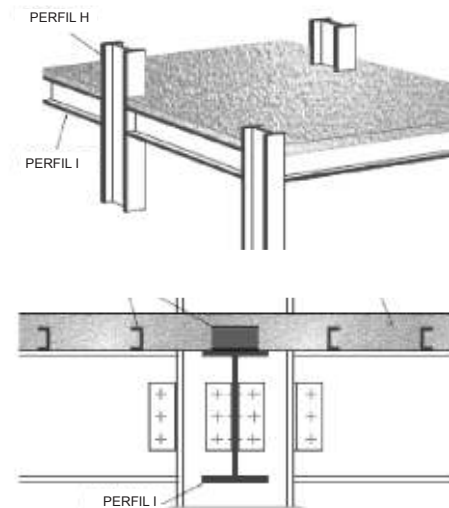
Laje de concreto armado moldada in loco e detalhe dos conectores de cisalhamento
